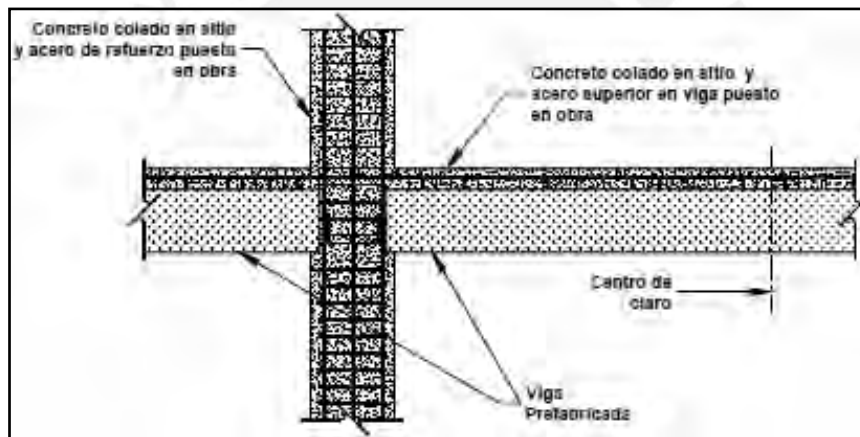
Vigas prefabricadas con conexión no emulativa semirrígida a columna (Rodríguez et al., 2013)
